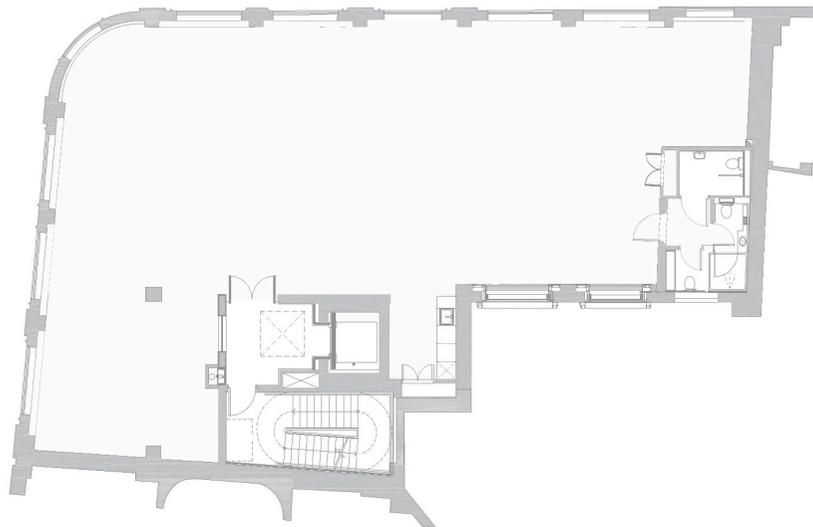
Axtell Soho*, pianta tipo dal 1° al 3° piano.
